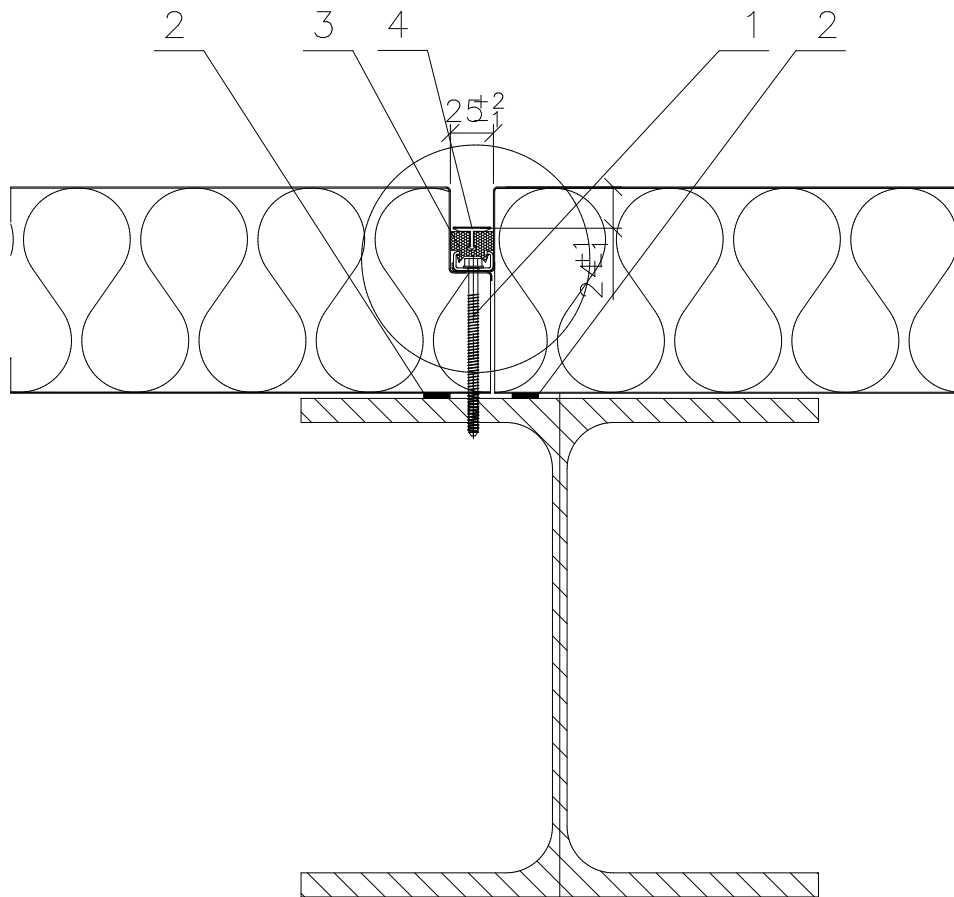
er – Panneau Qbiss One Power T (la pose horizontale)
